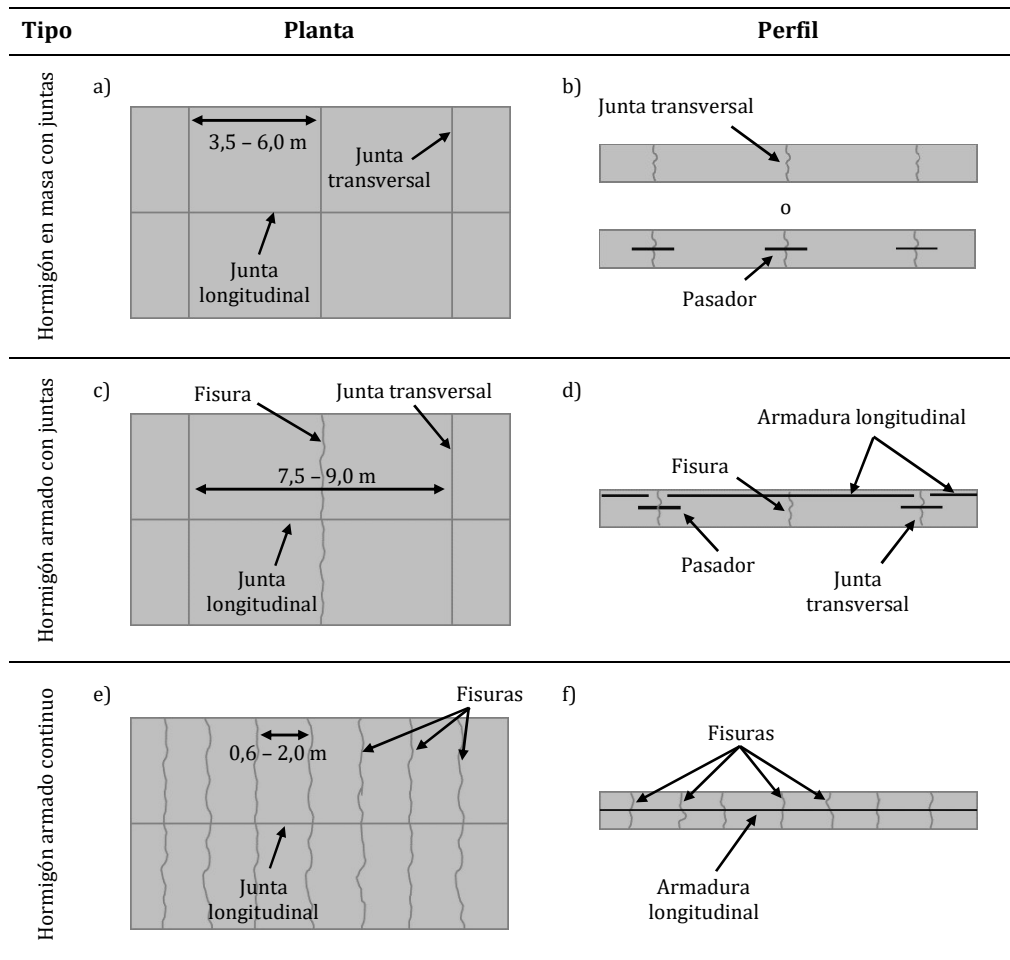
Planta y perfil de los diferentes tipos de pavimentos de hormigón.
